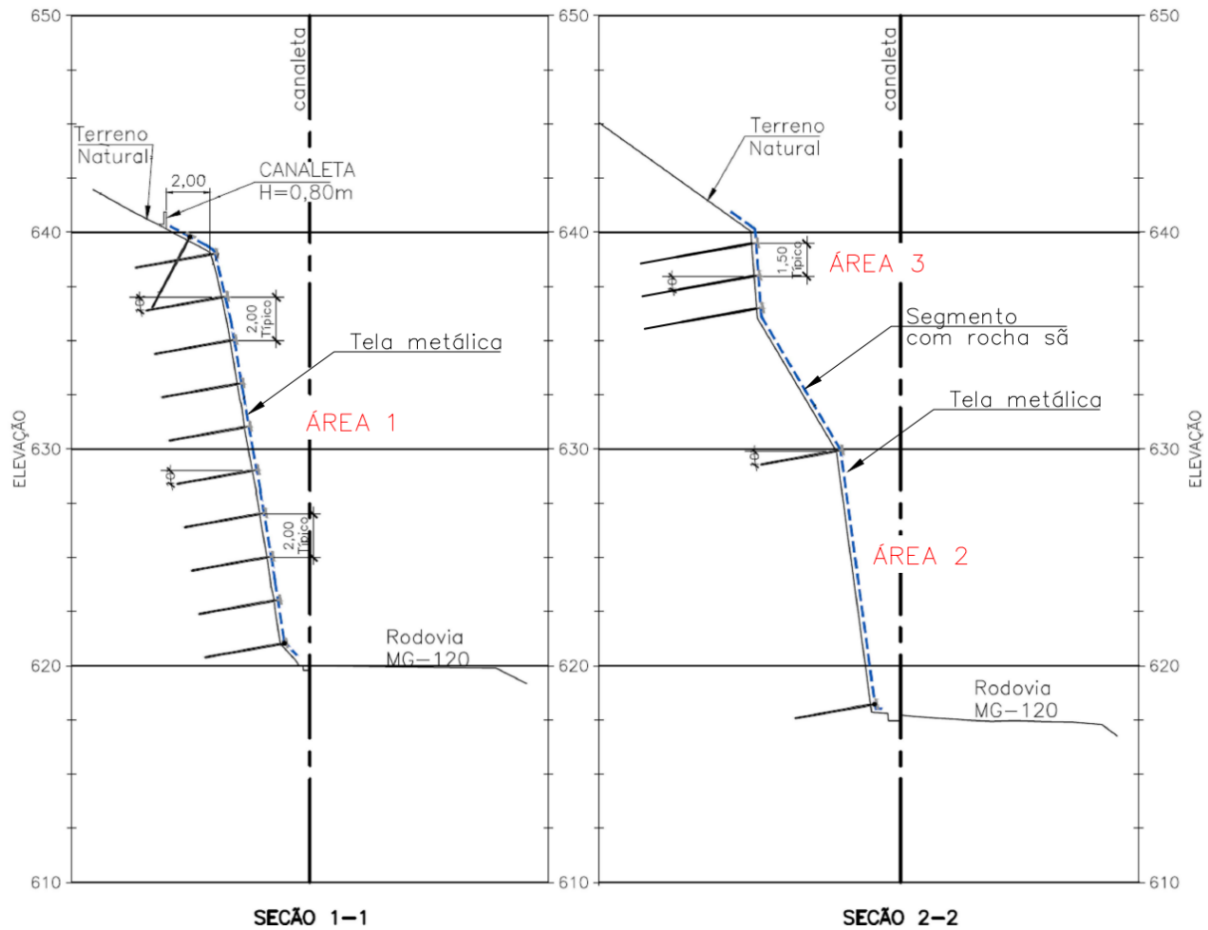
Seções transversais tipo do sistema de estabilização (ADAPTADO DE GEOPHI ENGENHARIA, 2023).
